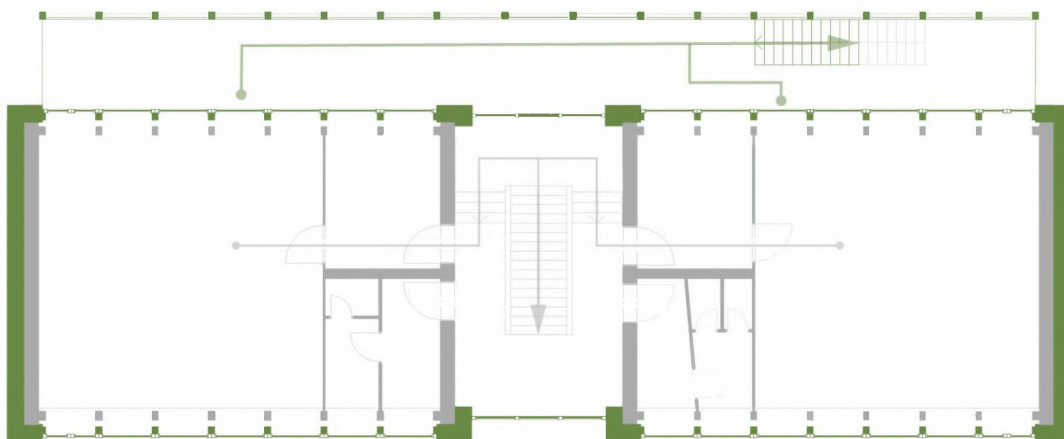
Grundriss 1. OG Verlauf Rettungswege, Quelle: FRANK mit Autodesk Revit erstellt
